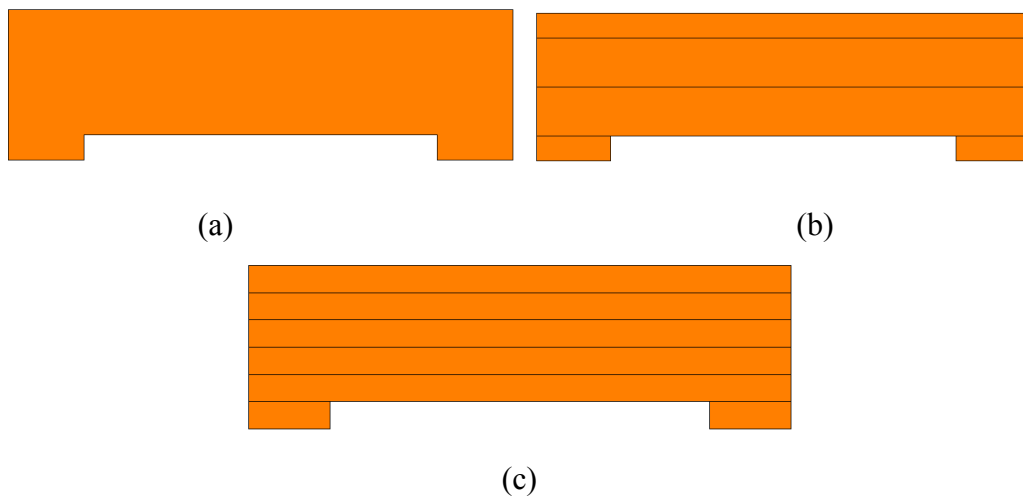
Modelos analisados numericamente: (a) Modelo 1 (MOD1 – mini parede sem armadura); (b) Modelo 2 (MOD2 – mini parede com armadura a cada duas juntas horizontais); (c) Modelo 3 (MOD3 – mini parede com armadura em todas as juntas horizontais).
